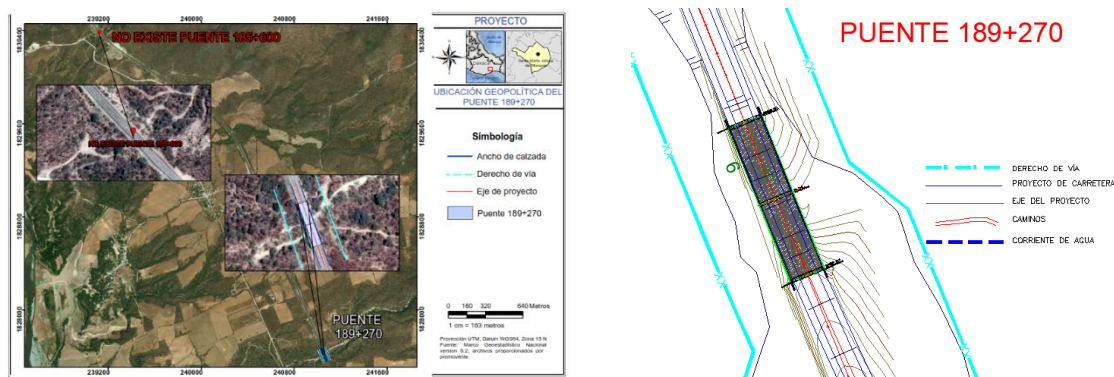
Proyecto en planta y perfil longitudinal del Puente 189+270.
